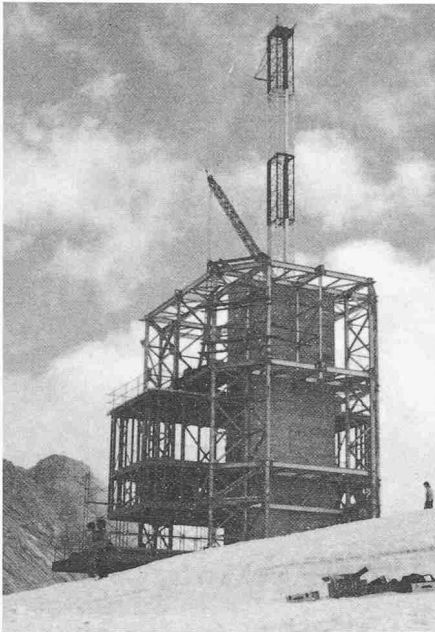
Montage mit speziellem Kran, der im Liftschacht versenkbar ist
